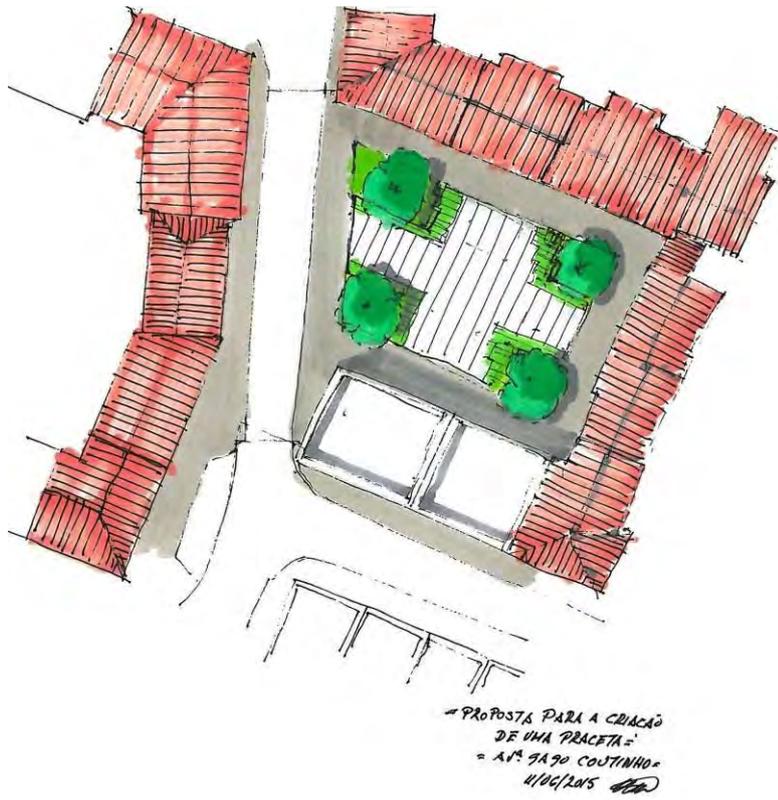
Planta de intenção de desenho urbano na Praça Sacadura Cabral
